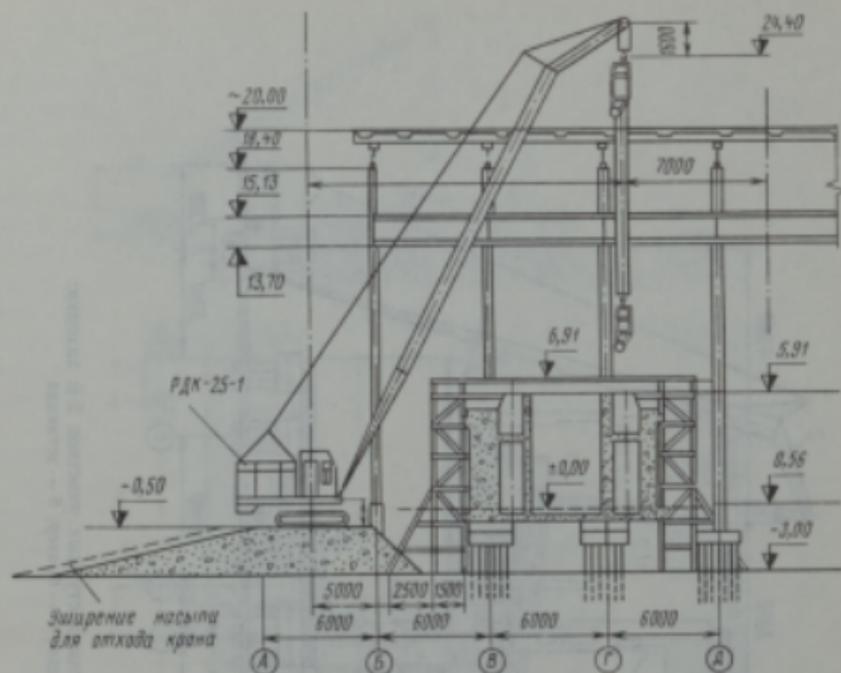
Схема организации бетонирования 2-й заходки вентиляционного канала
